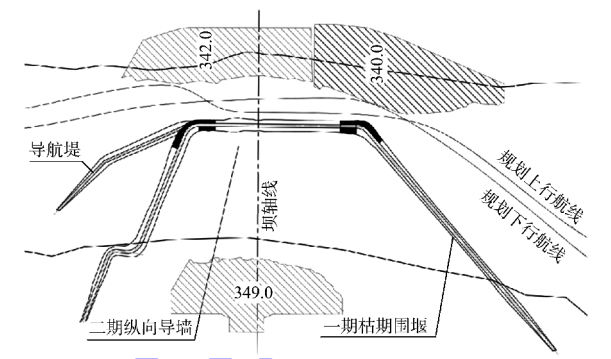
一期一枯原设计方案坝区围堰平面布置 (单位: m)
